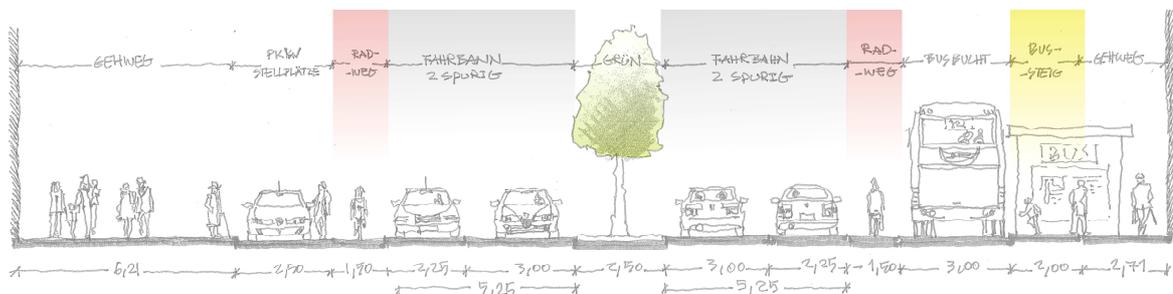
Skizze Straßenquerschnitt Variante 2; Höhe City Center
